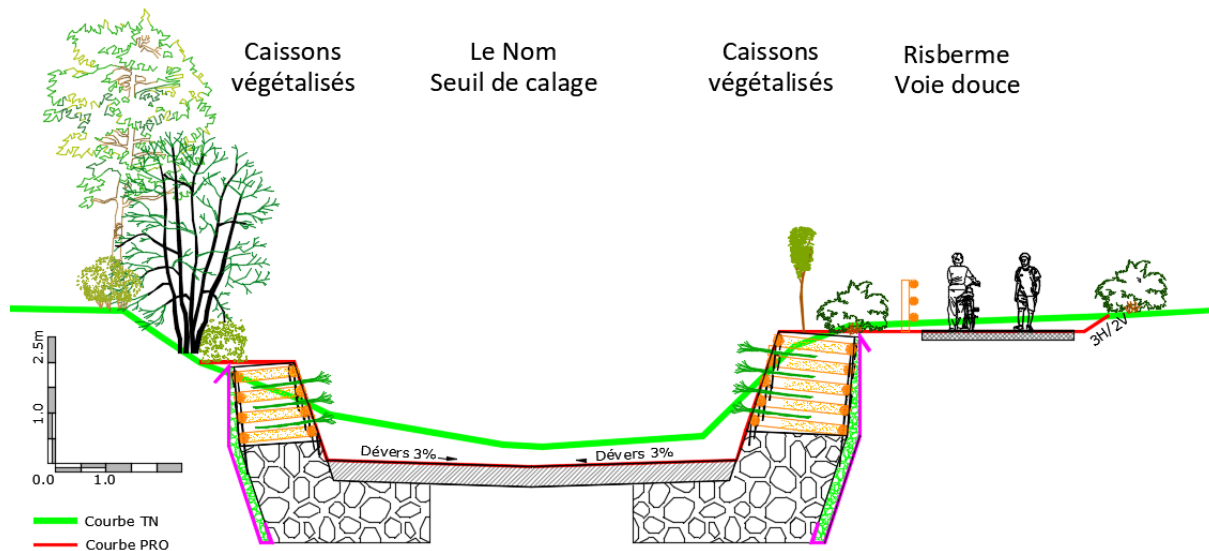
Coupe type de la risberme et des protections de berges du secteur nouveau pont à future passerelle
